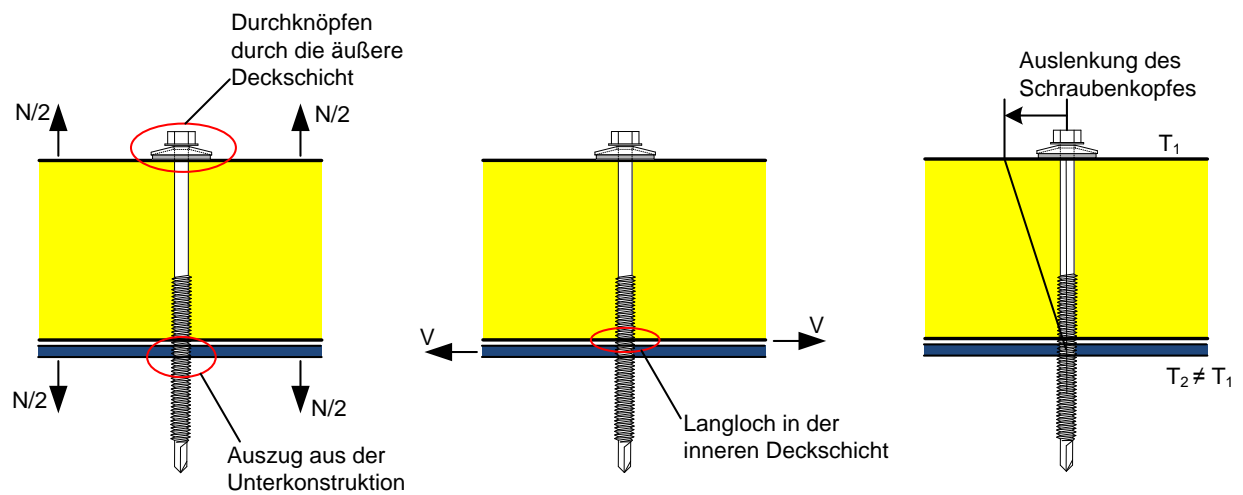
Versagensmodi von Sandwichbefestigungen
